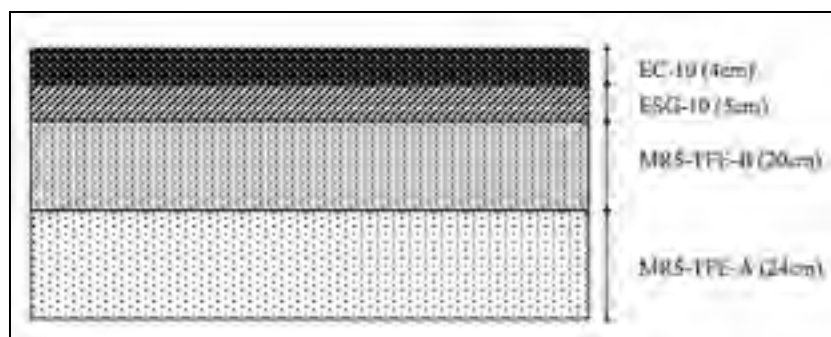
Schéma des différentes couches de la structure de la chaussée instrumentée (coupe transversale)
